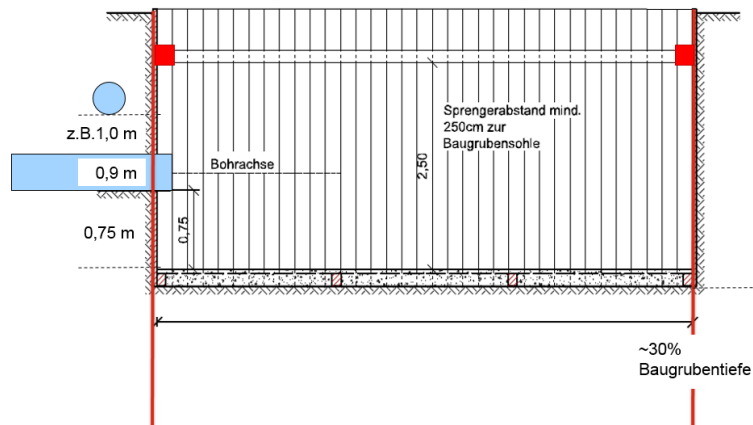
Querschnitt Start/Zielbaugrube
